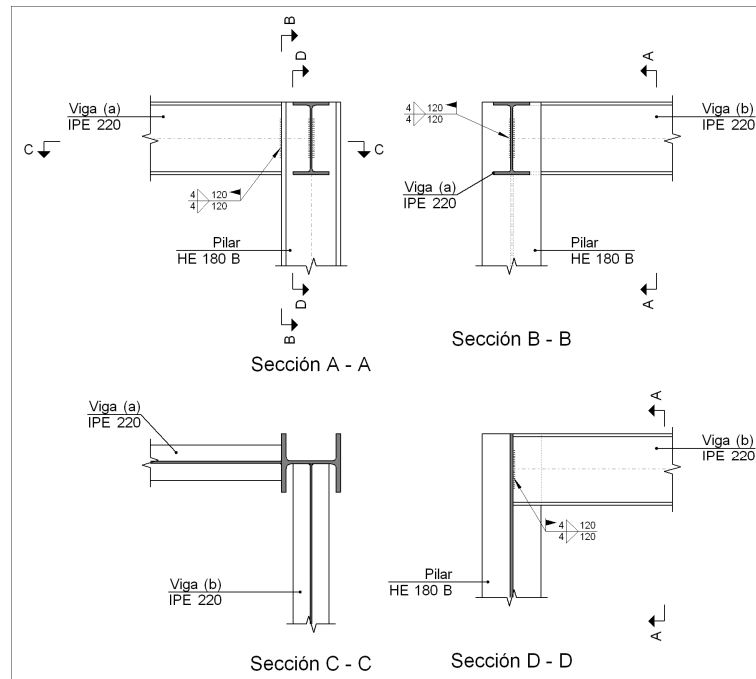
Detalle de las soldaduras tipo 3 del soporte inferior
